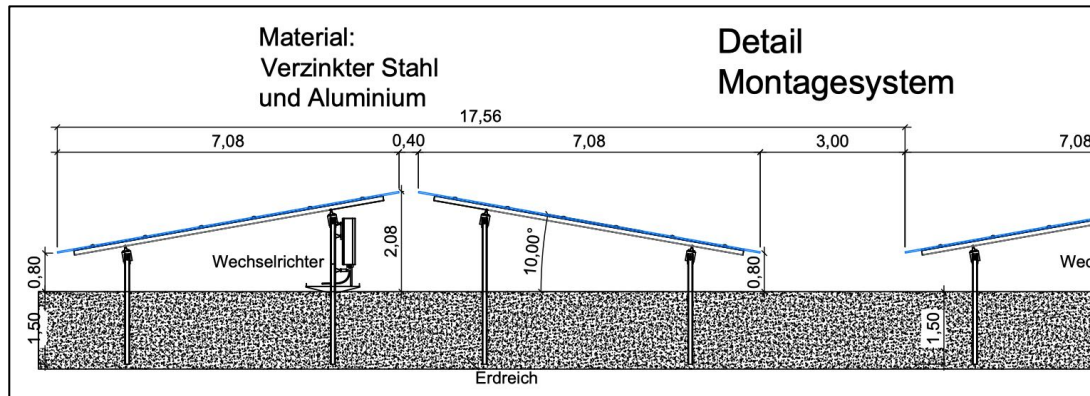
Detail Montagesystem - Auszug Belegungsplan
